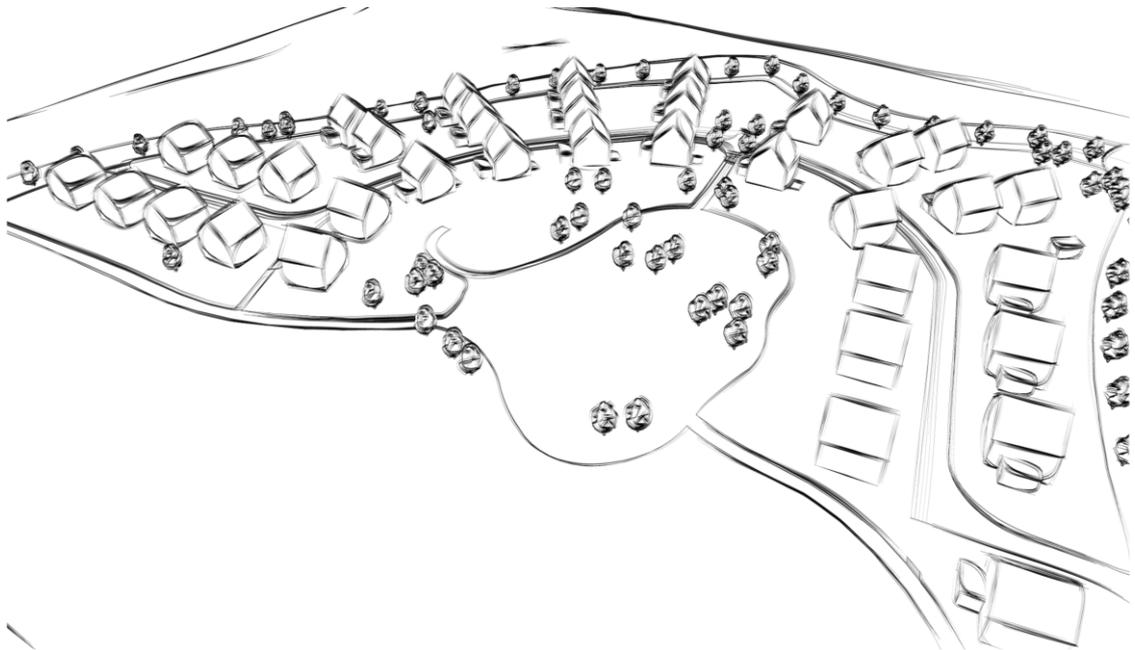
D-Darstellung der geplanten Bebauung, Fachdienst 61
